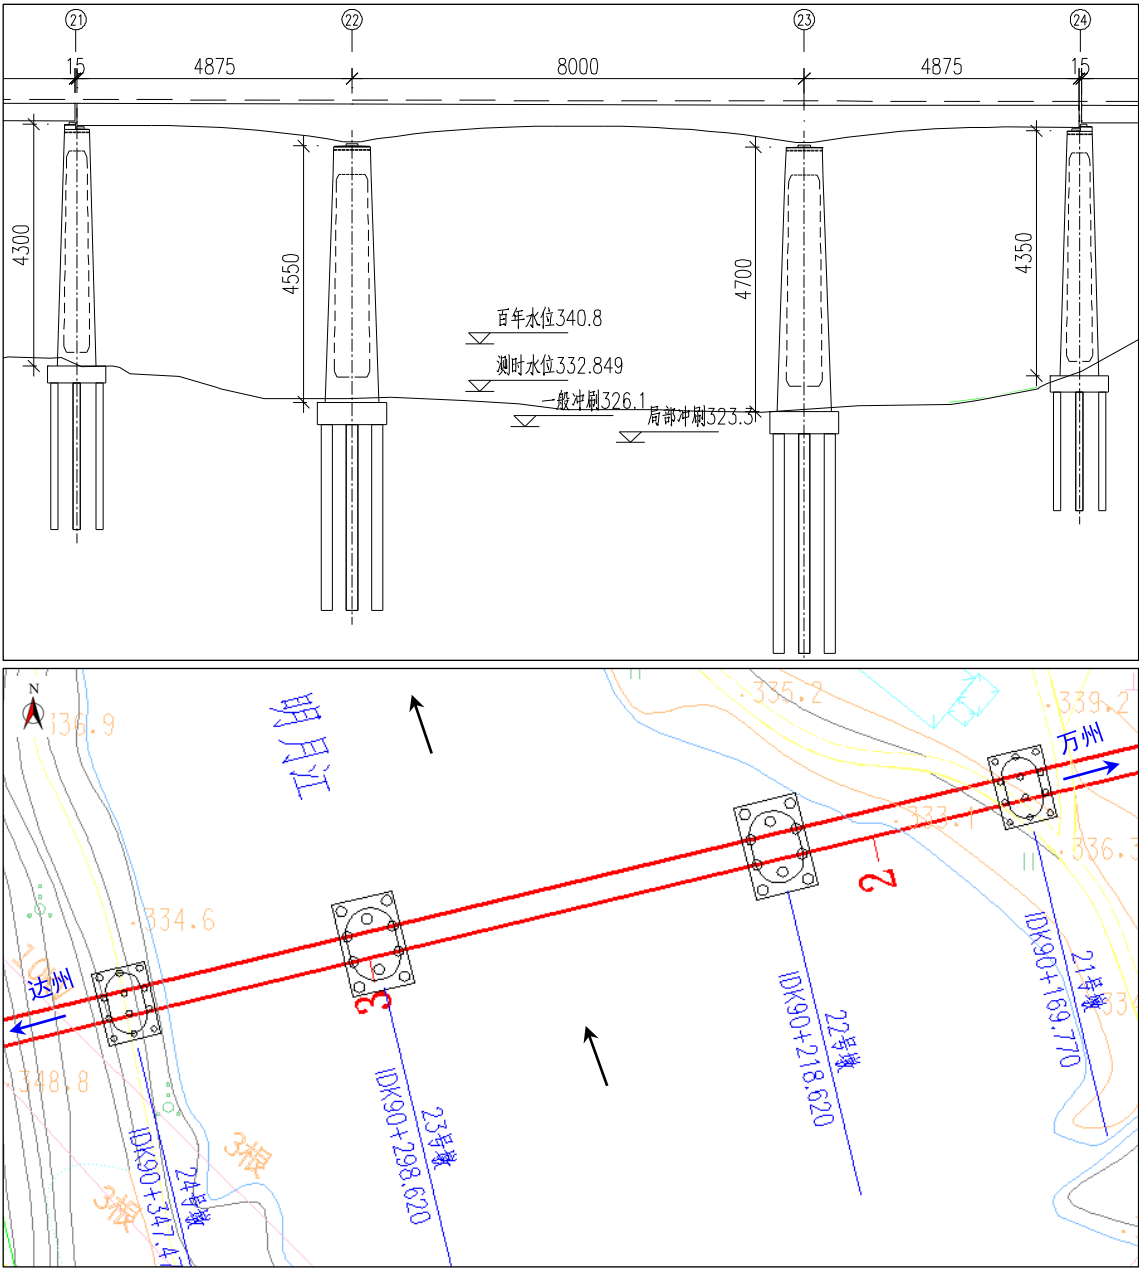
亭子镇明月江特大桥桥台立面、平面布置示意图
